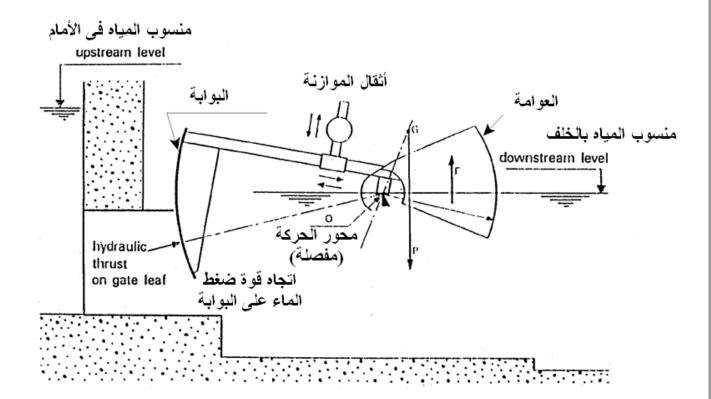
مبدأ تشغيل بوابات التصرف الثابت
